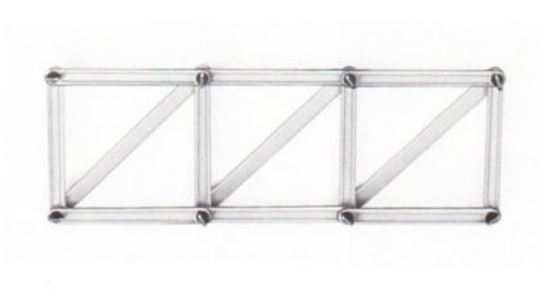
Eine weitere Kombination: Drei Vierecke, jeweils in zwei Dreiecke – und damit starr – aufgeteilt, ergeben insgesamt ein starres Fachwerk.
